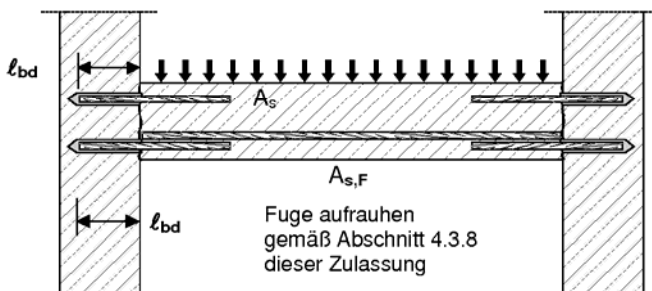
Bewehrungsanschlüsse überwiegend auf Druck beanspruchter Bauteile. Die Bewehrungsstäbe sind Druckbeansprucht.
